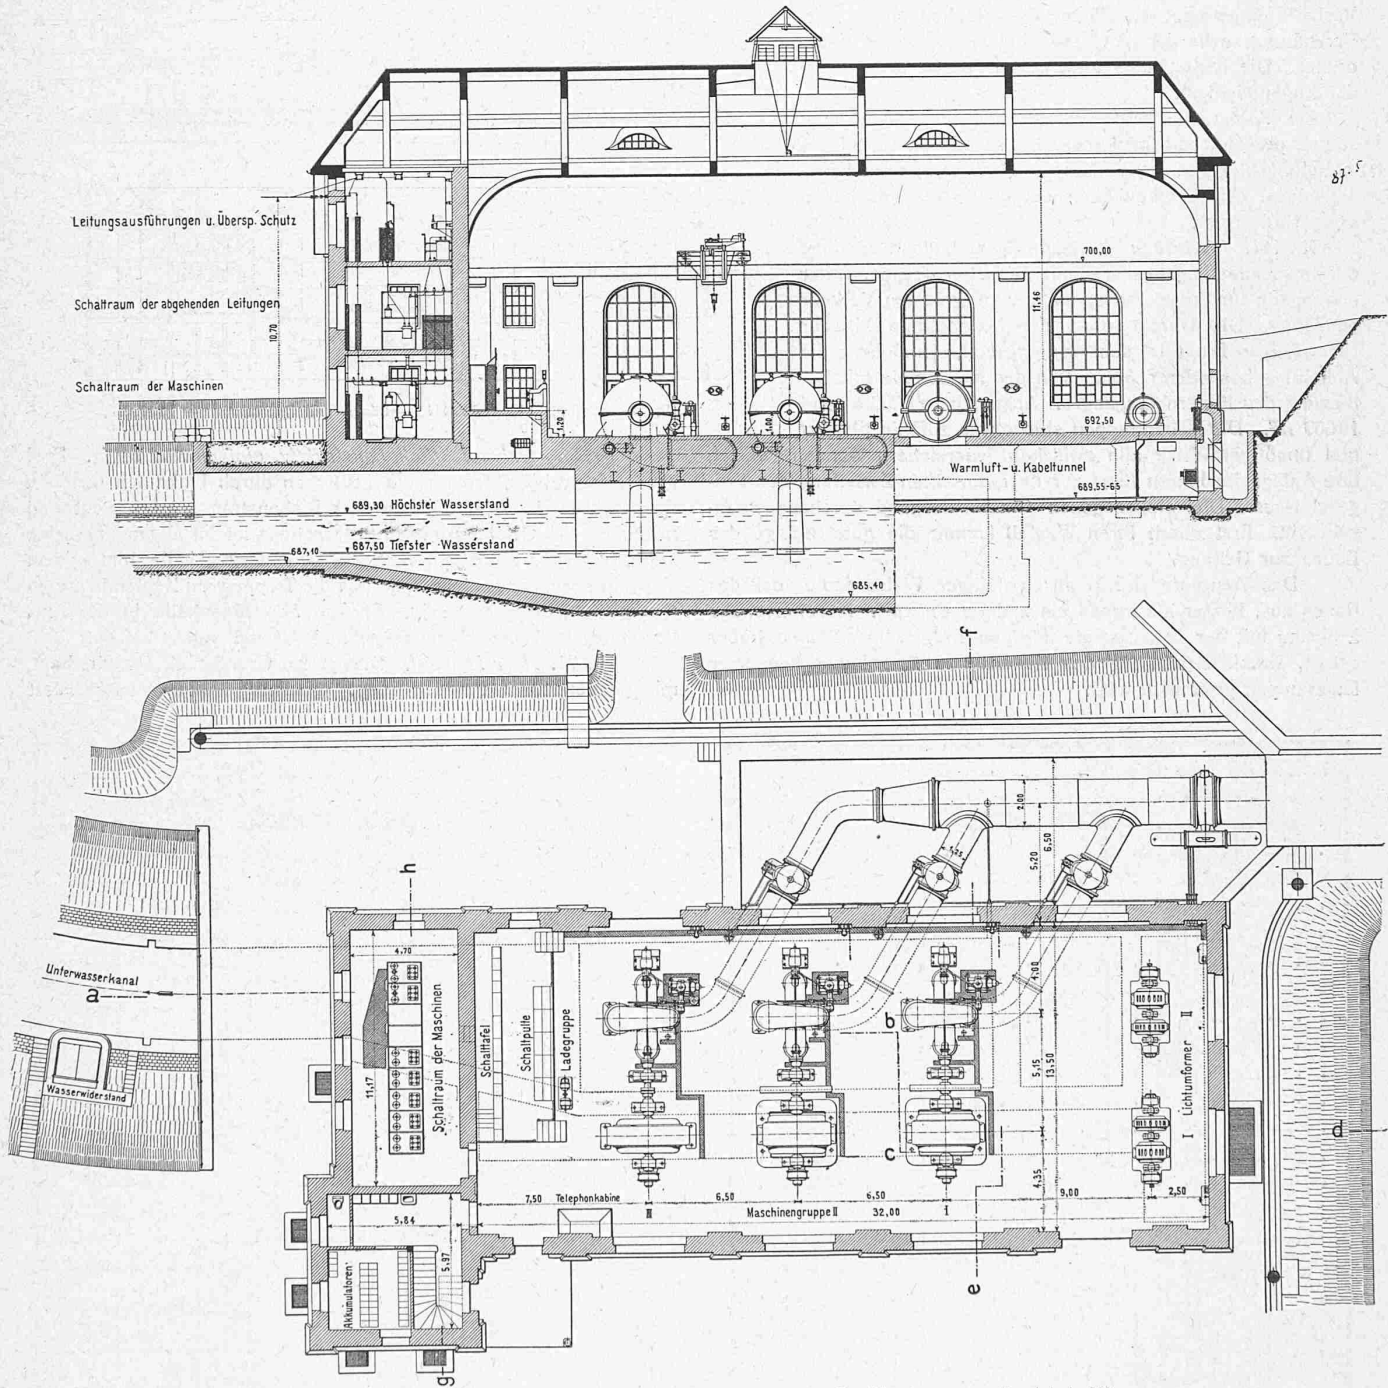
und 17. Grundriss und abgestufter Längsschnitt a-b-c-d des Maschinenhauses. — Masstab 1 : 300.
